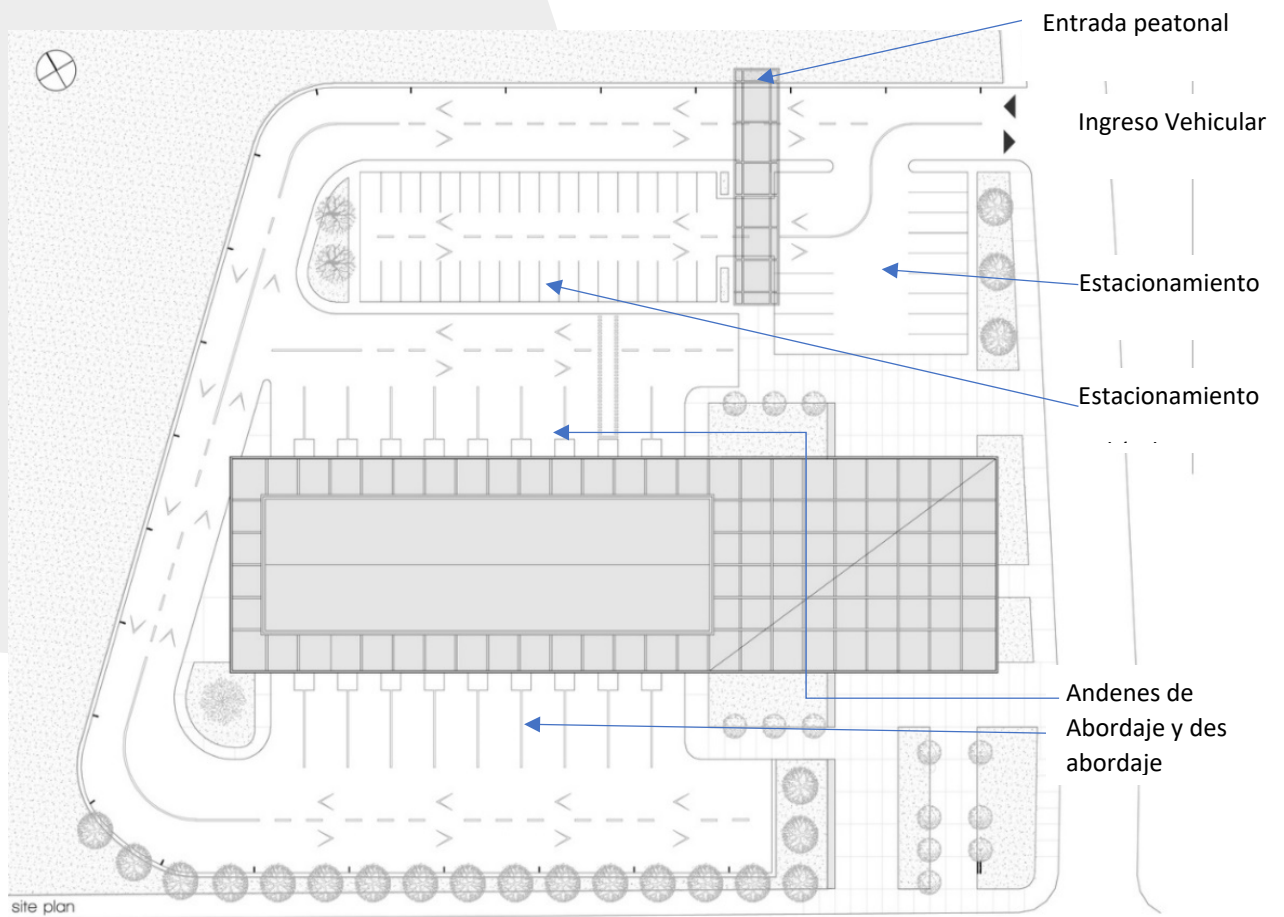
Planta de Conjunto Estación de Buses Luleburgaz.
